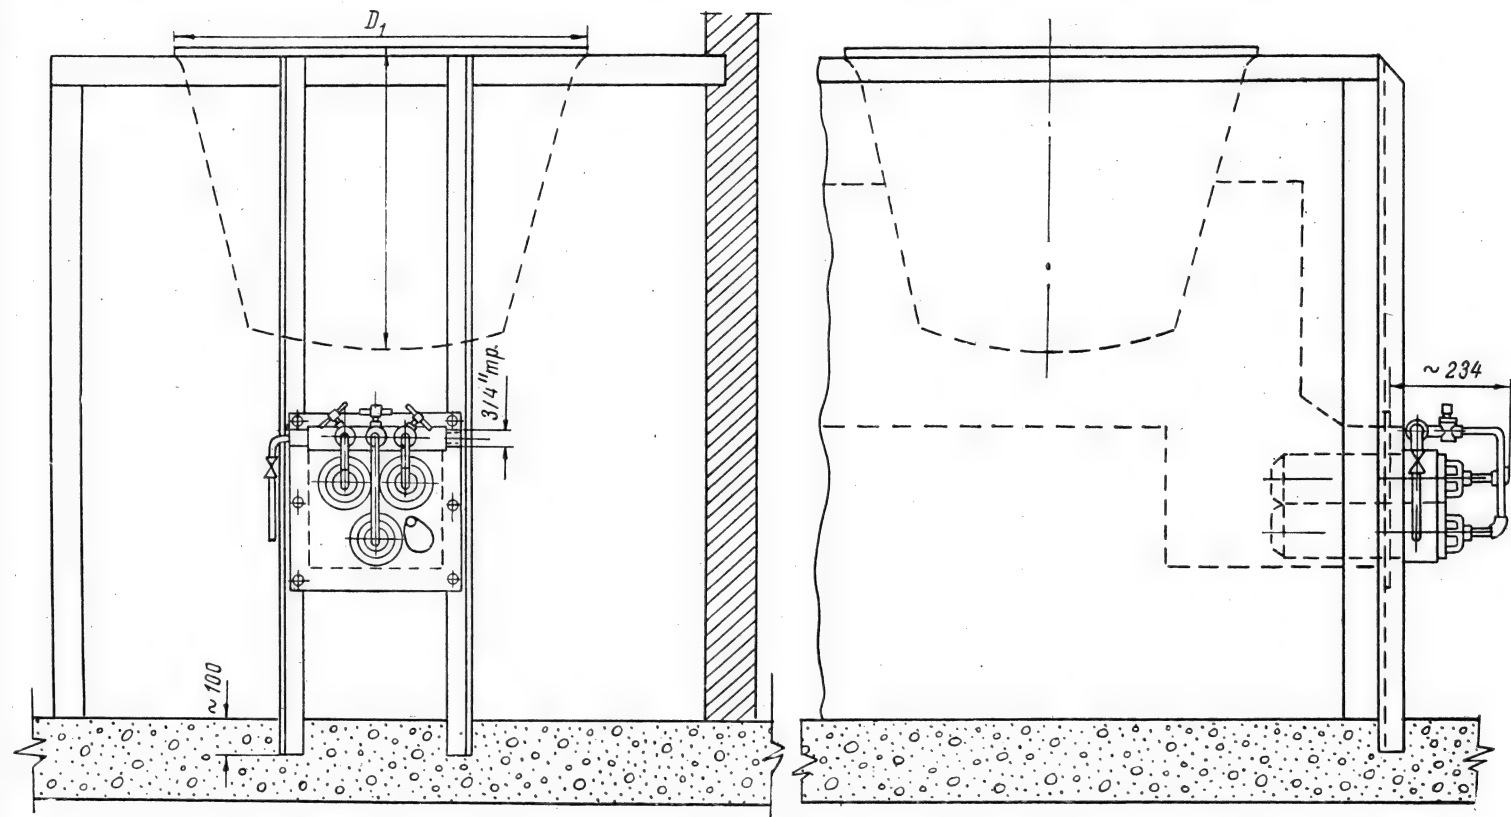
Схема переоборудования варочных котлов с дровяной топкой на газовое топливо.
